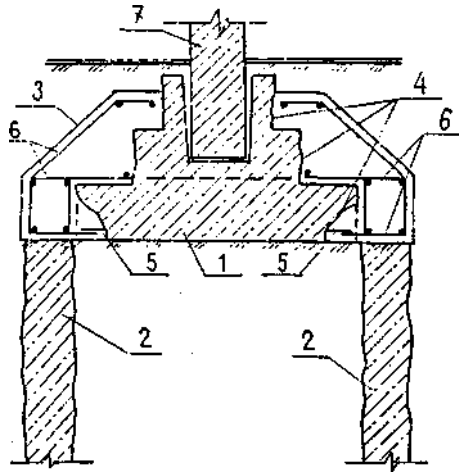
Передача навантаження від фундаменту на залізобетонні палі занурювані задавливанням
